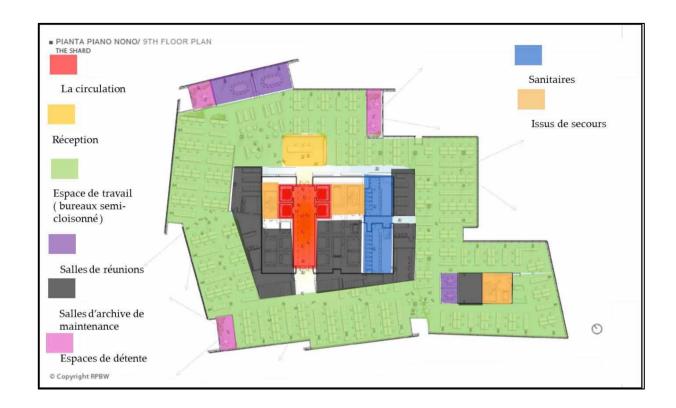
plan du 9 eme étage www.pinterest.com/Auteurs
